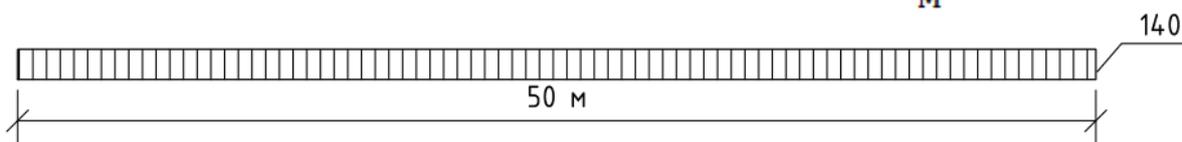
Схема распределения веса снегового покрова на плоской кровле здания
